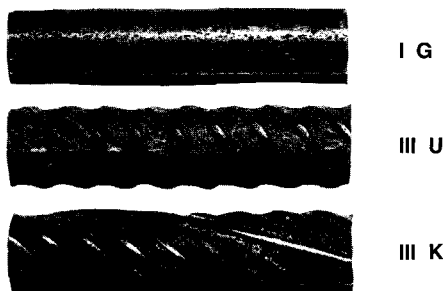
Einige Betonstabstähle nach DIN 488
